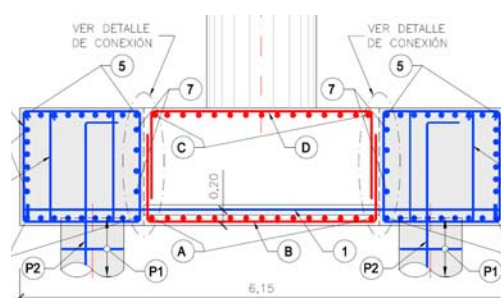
Detalle de armadura tipo Gewi Ø63,5mm, atravesando zapatas existentes.
